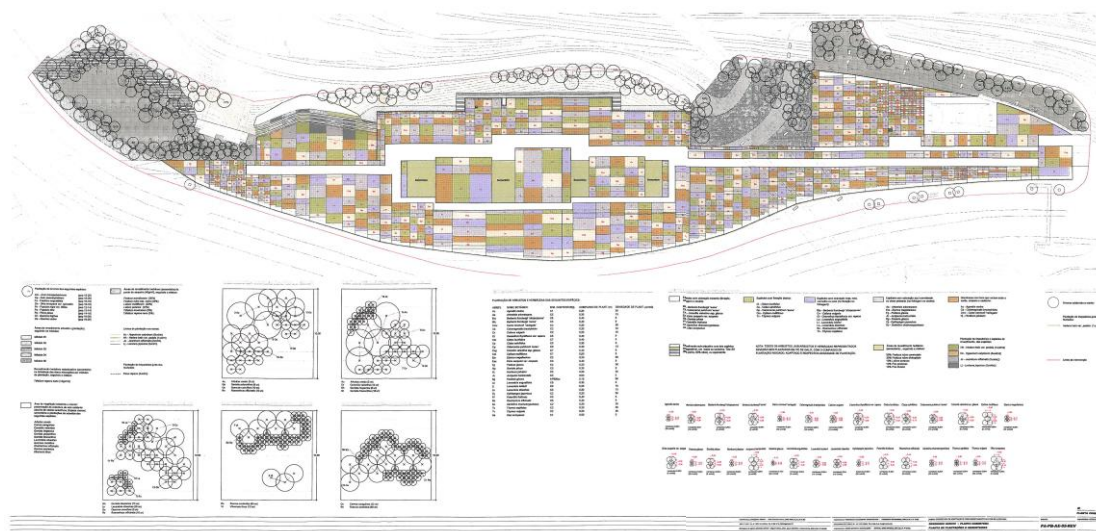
planta de plantação e sementeiras do projecto Etar de Alcântara
